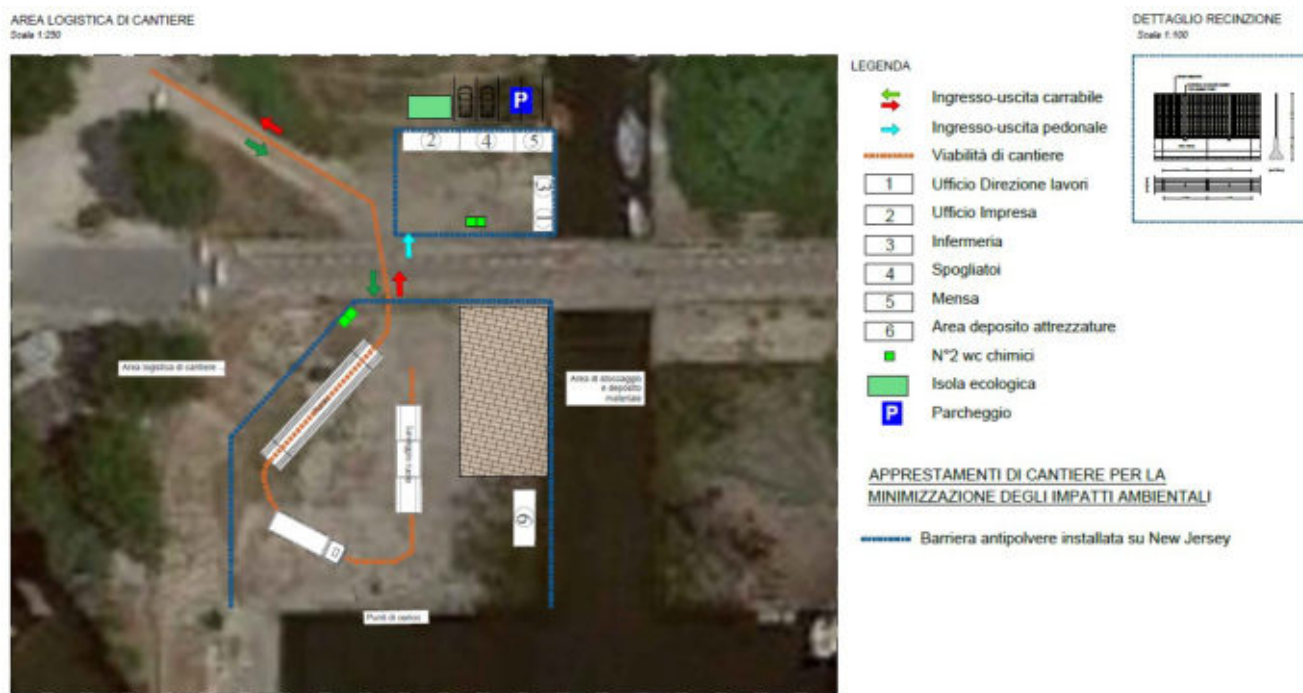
Planimetria dell'area di cantiere localizzata presso la Foce del Verde.
